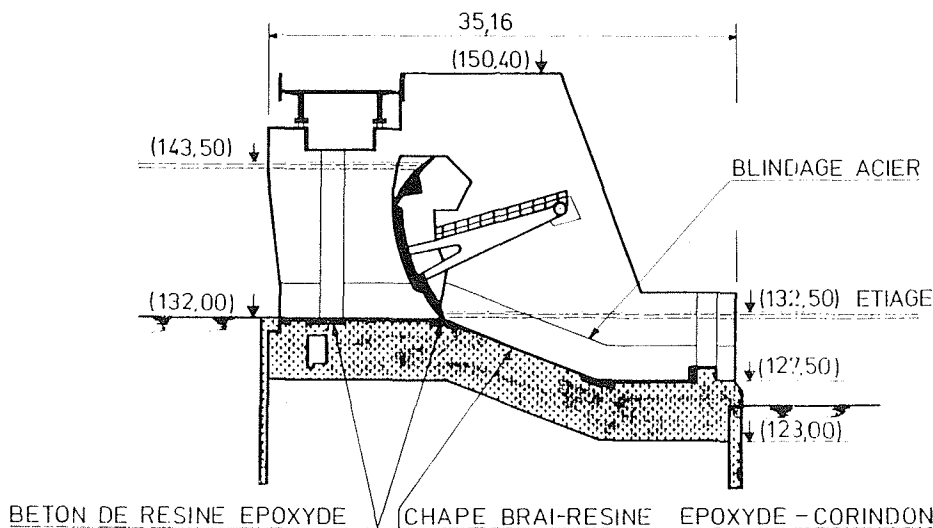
Coupe du barrage de Saint-Pierre de Boeuf
